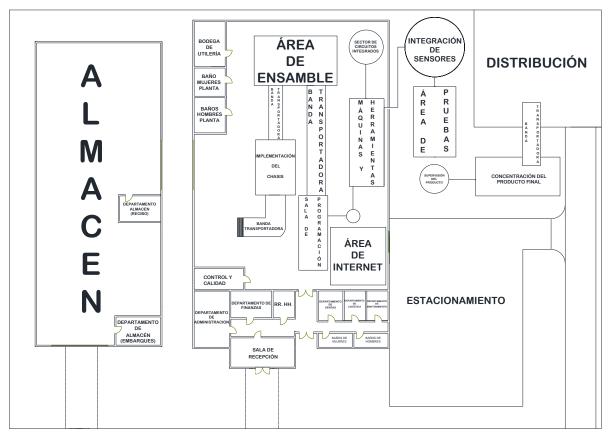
Planta de GAIMFE S.A. DE C.V.
